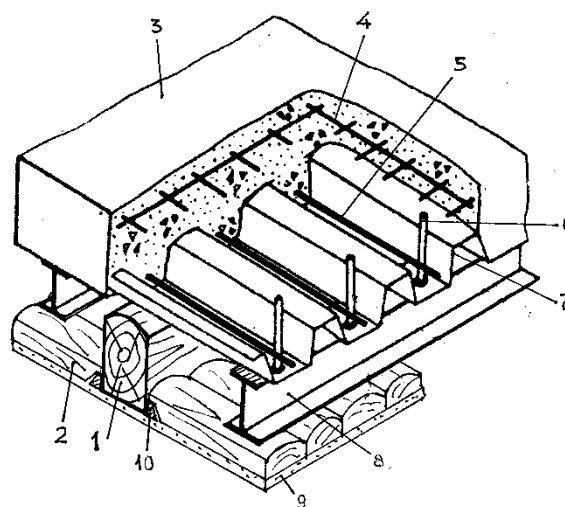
Варіант конструктивного рішення підсилення перекриття шляхом влаштування монолітного залізобетонного перекриття по сталевим балкам з незнімною опалубкою з профільованого сталевго листа
